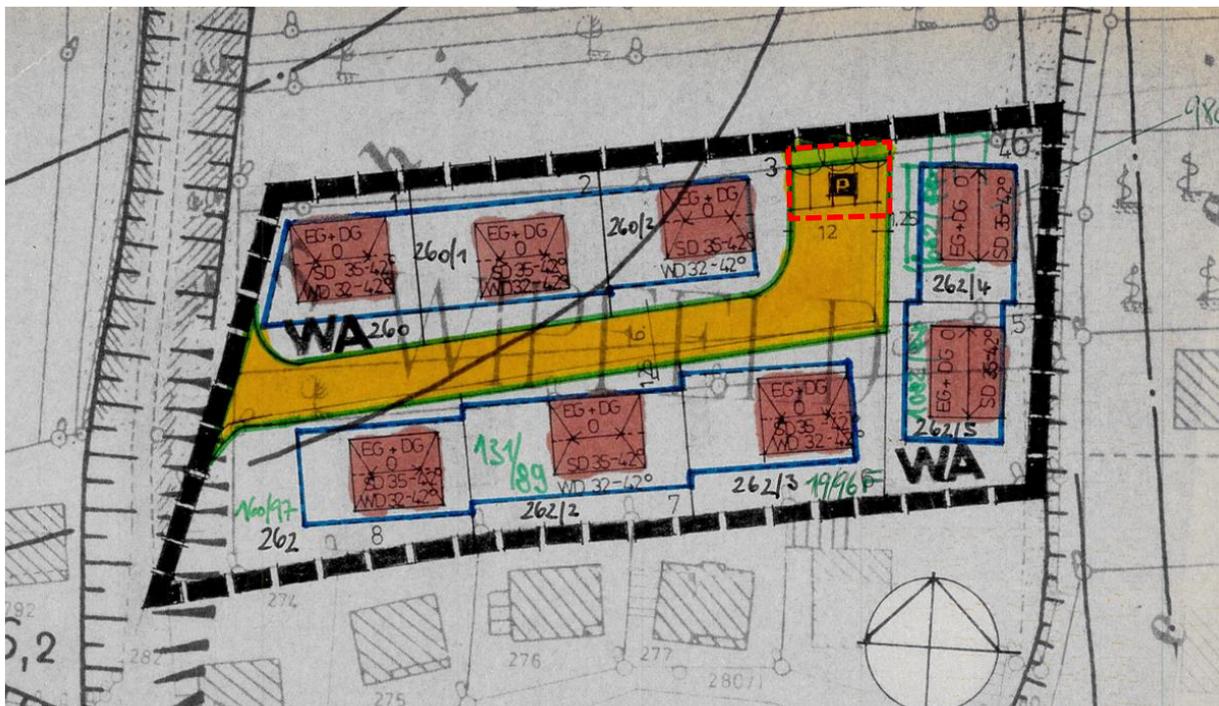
1. Änderung Bebauungsplan „Thiergärten“
